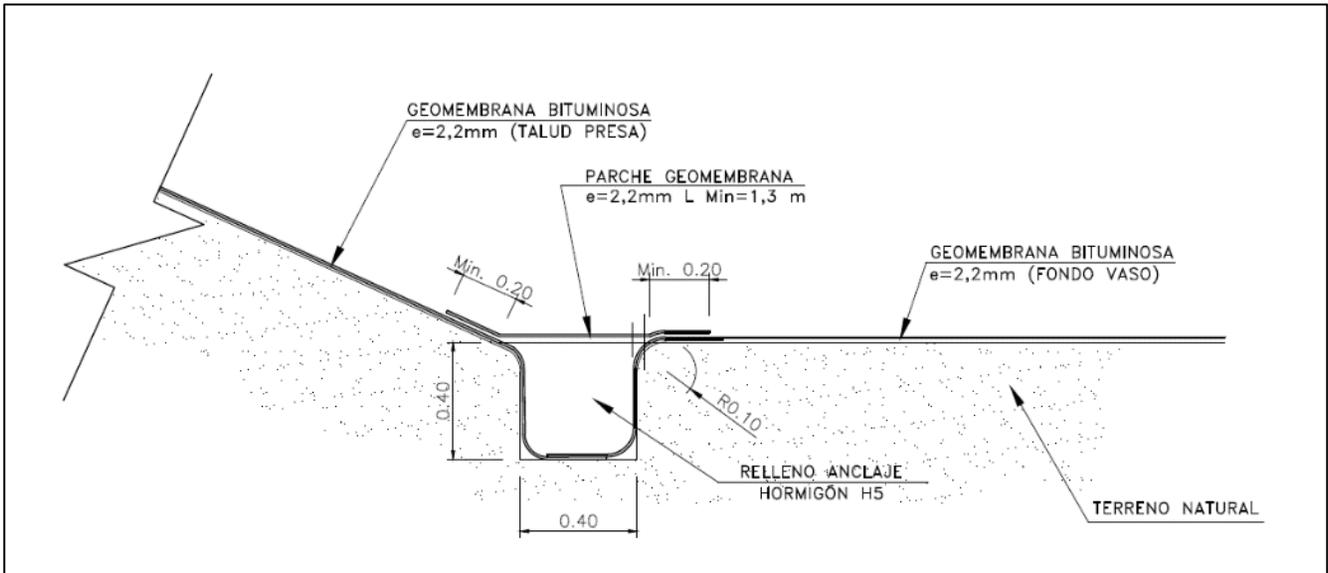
Esquema Instalación de Geomembrana en Fondo del Tranque
